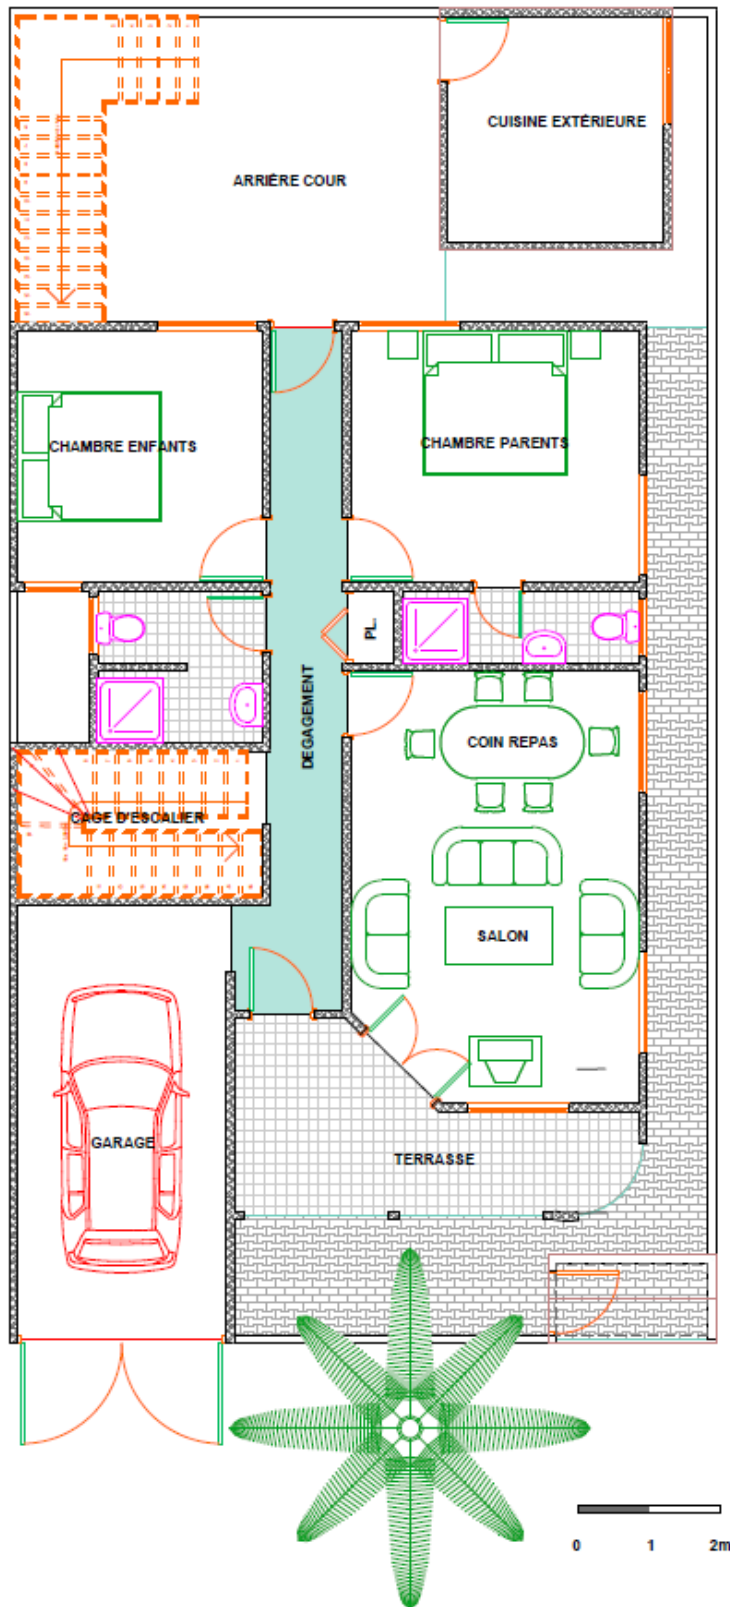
Plans de la maison individuelle de Monsieur O.D. : Rez- de- chaussée habité.
